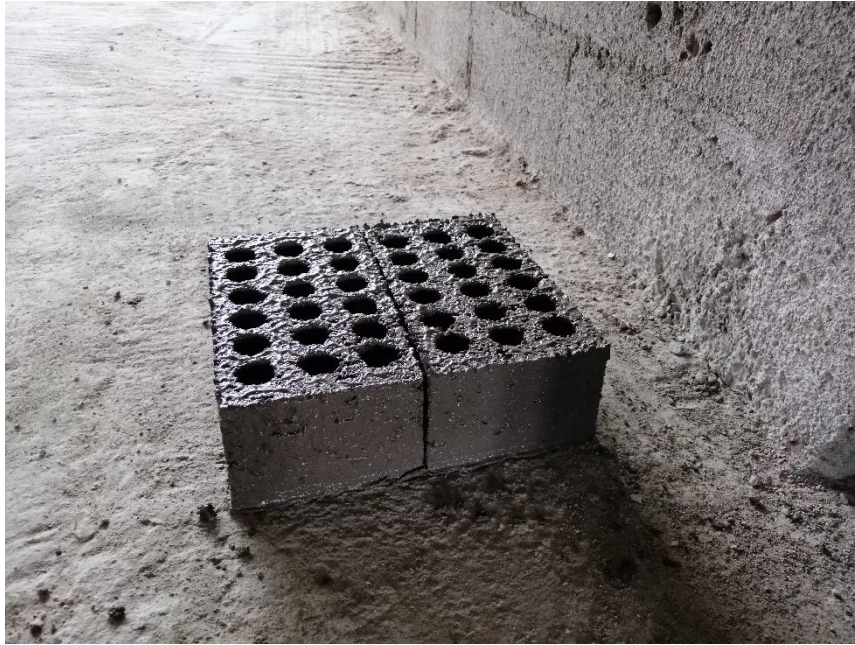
Unidad de albañilería de Concreto King Kong de 18 huecos.
